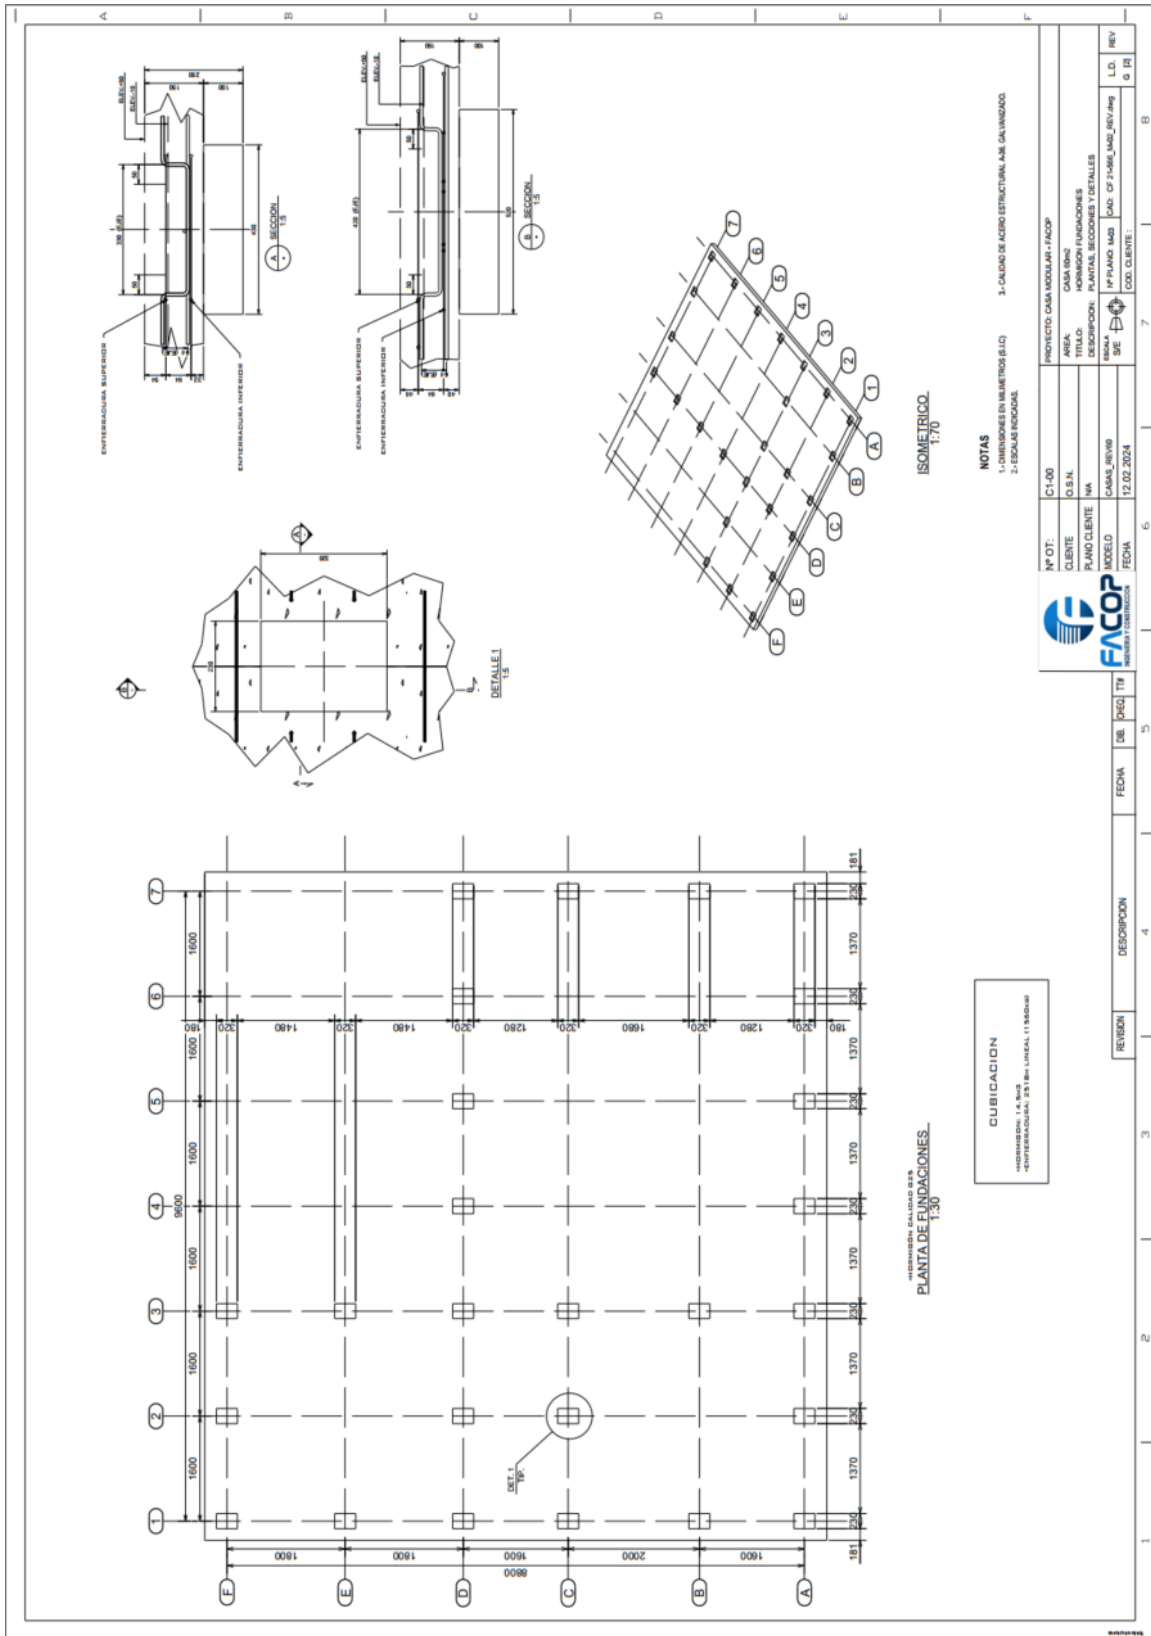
Plano de montaje: Fundaciones-hormigón
